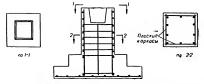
133. Железобетонный фундамент под сборные колонны с повышенной стаканной частью.
